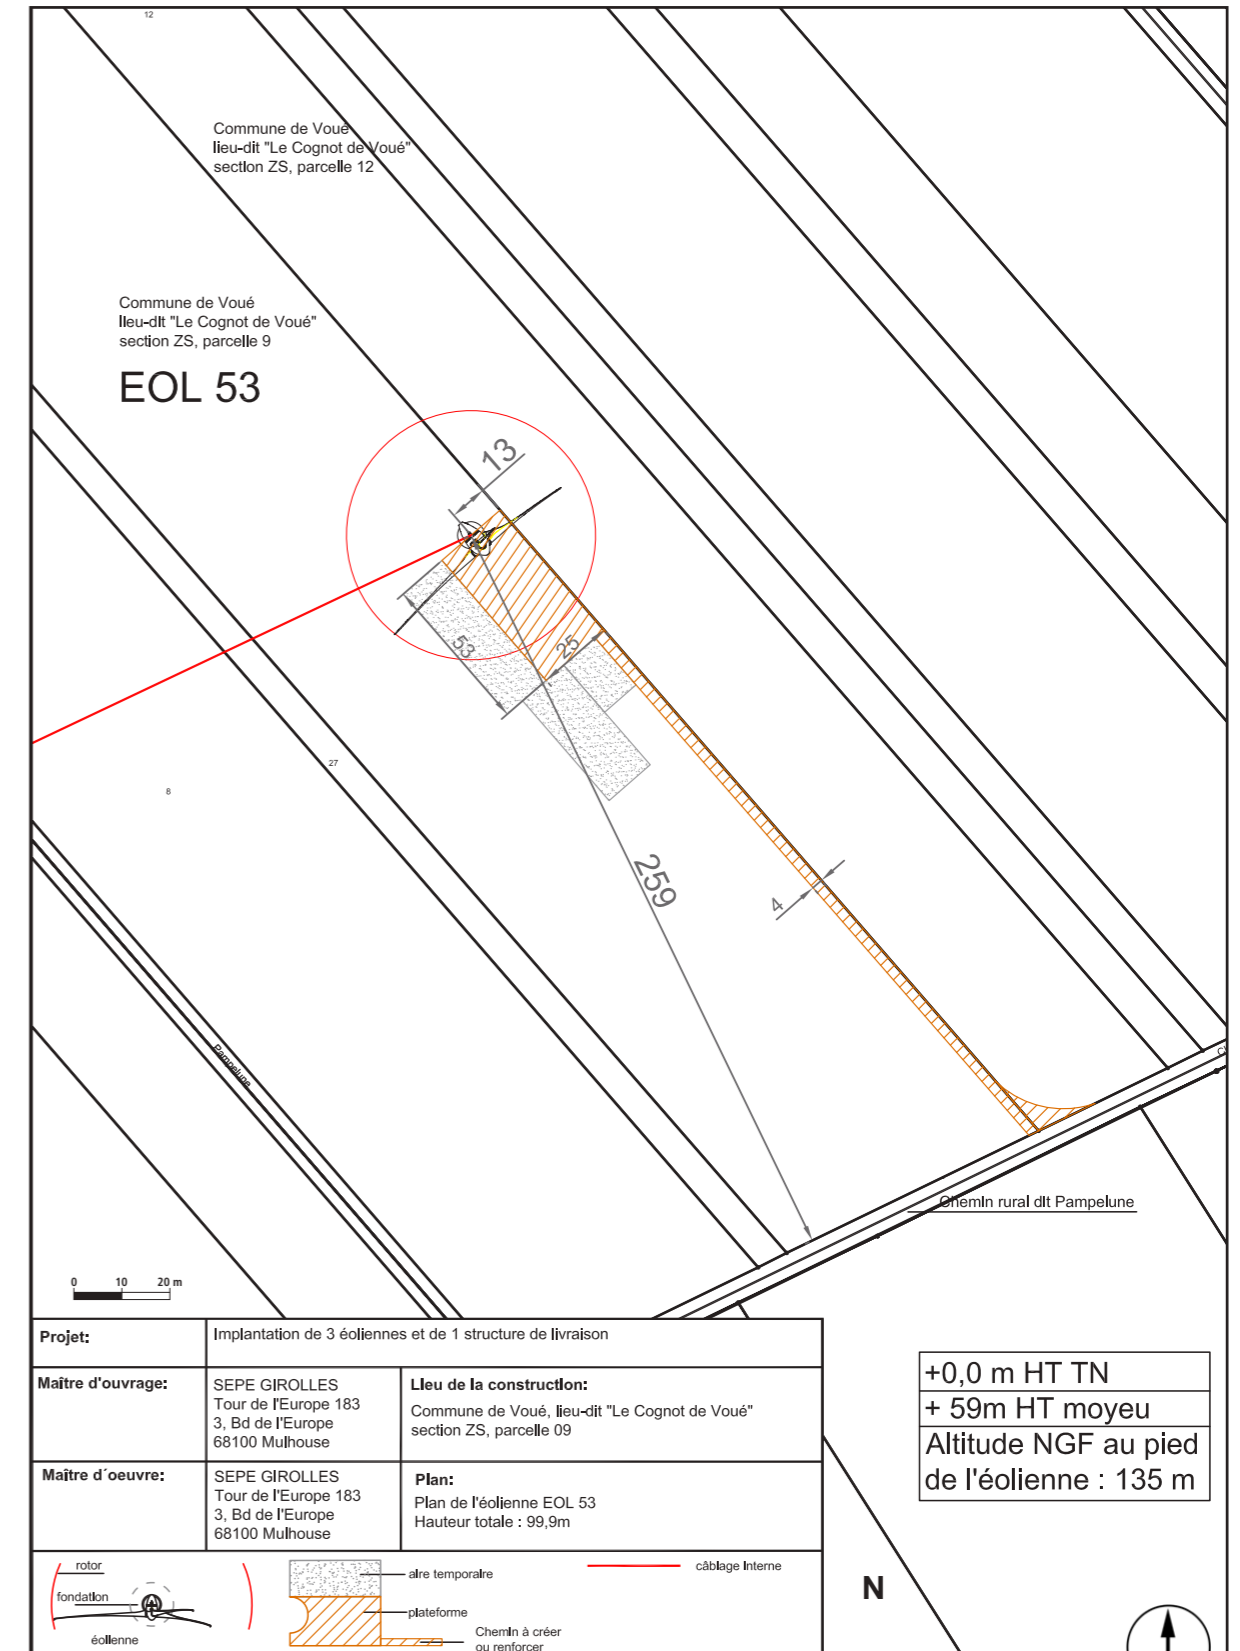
Carte de l'implantation de l'éolienne EOL 53 sur le plan cadastral
